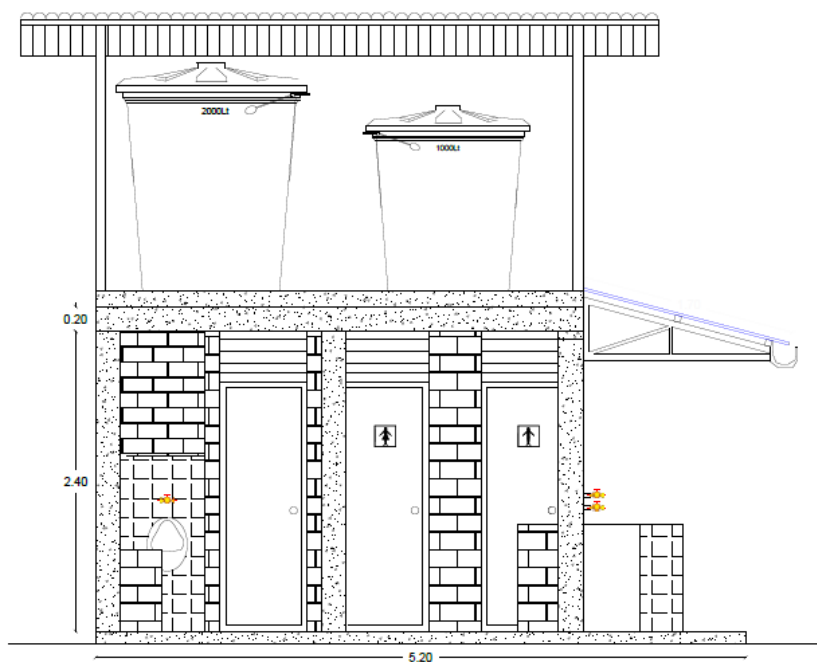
Plano vista de fachada batería sanitaria Casa Cabildo
